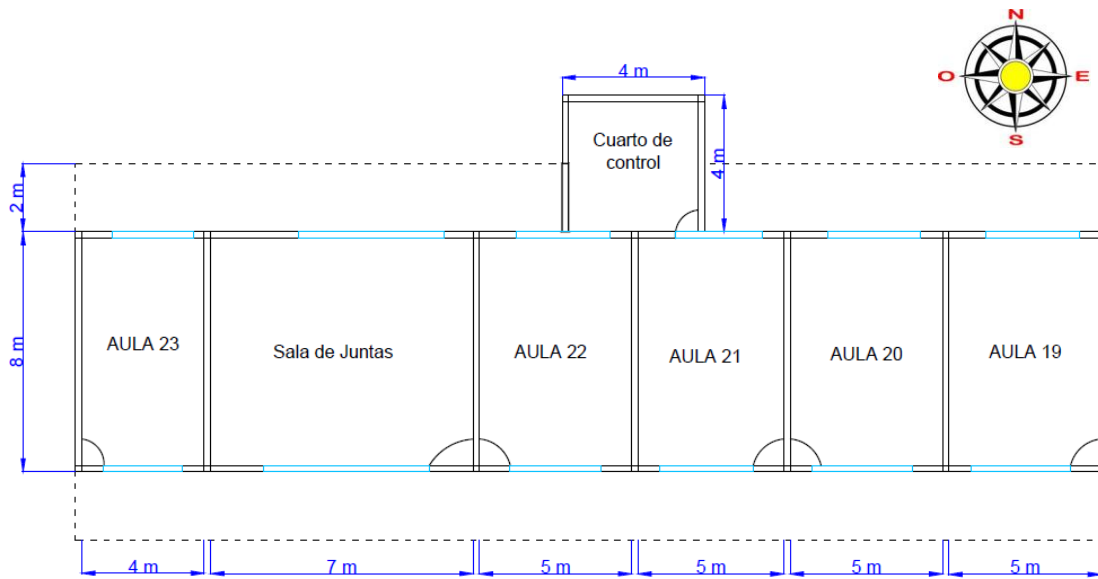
^b Vista esquemática plana del edificio H de posgrado, Facultad de Ingeniería UAQ.
